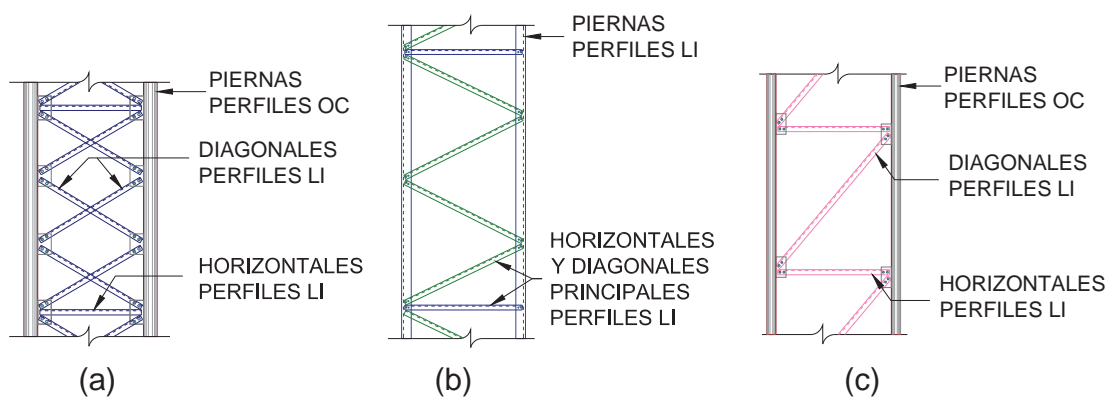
Configuración de la celosía de las torres (sección constante)
